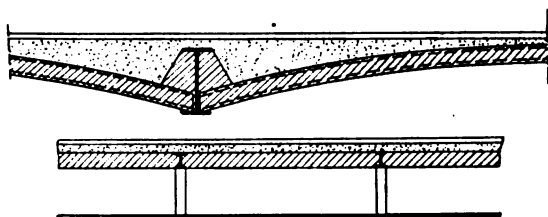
und 152. Längen- und Querschnitt durch ein Gewölbe nach System Melan.
